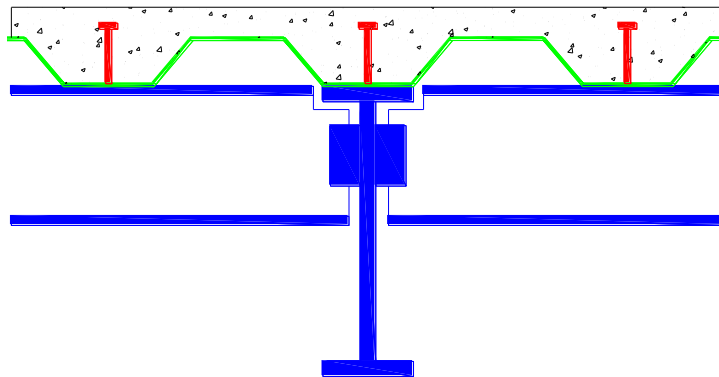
Sistema de piso, viga de acero y losa de concreto rellena con concreto, unida mediante conectores de cortante
